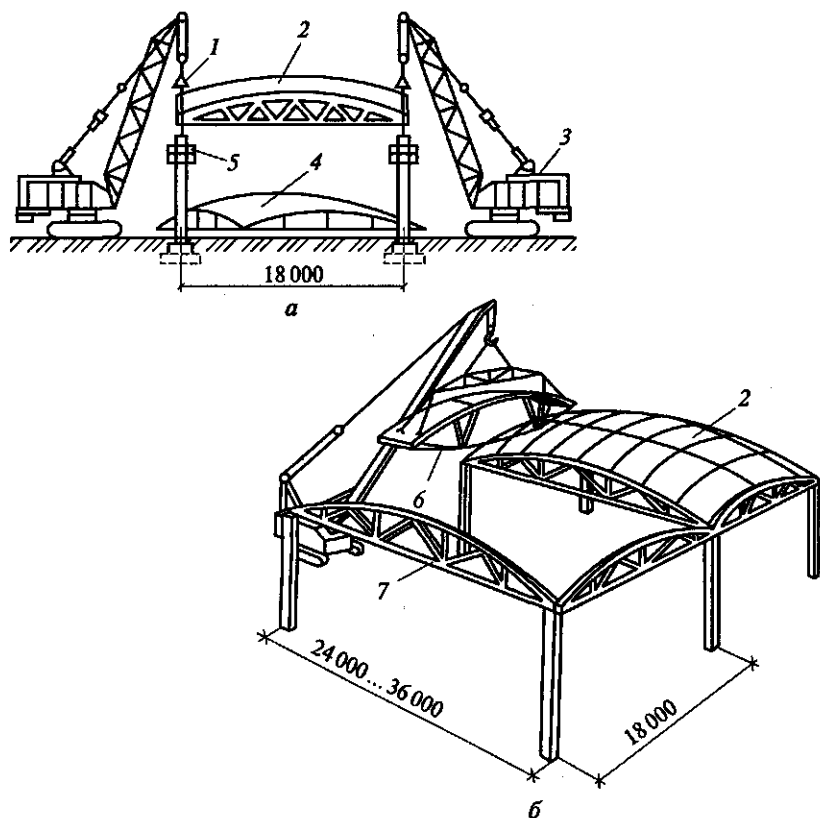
Схемы монтажа железобетонных оболочек:
